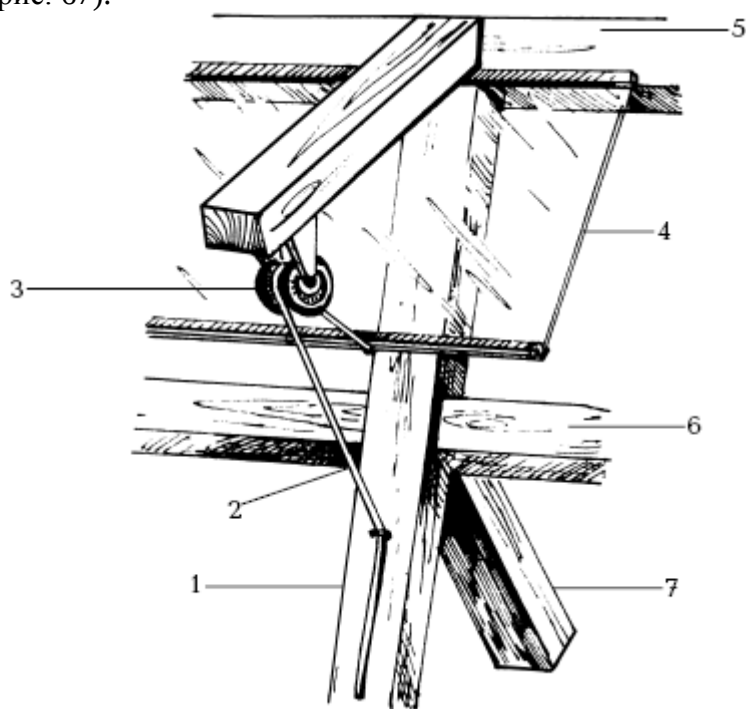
Монтаж фрамуги: 1) центральная опора; 2) шнур; 3) блок; 4) фрамуга; 5) верхний коньковый брус; 6) нижний коньковый брус; 7) стропило с южной стороны
